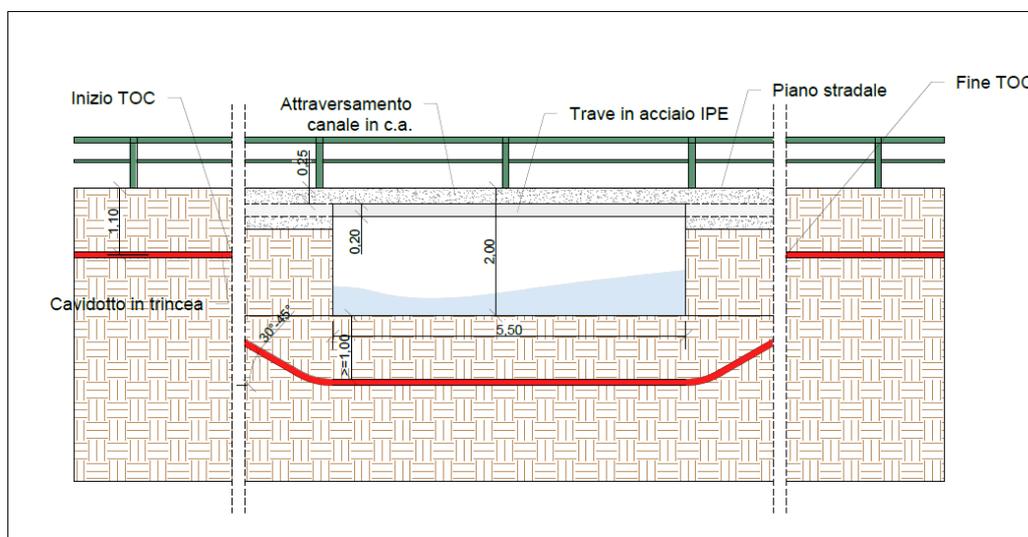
Attraversamento idraulico n.32 – Sezione tipologica attraversamento tramite TOC
